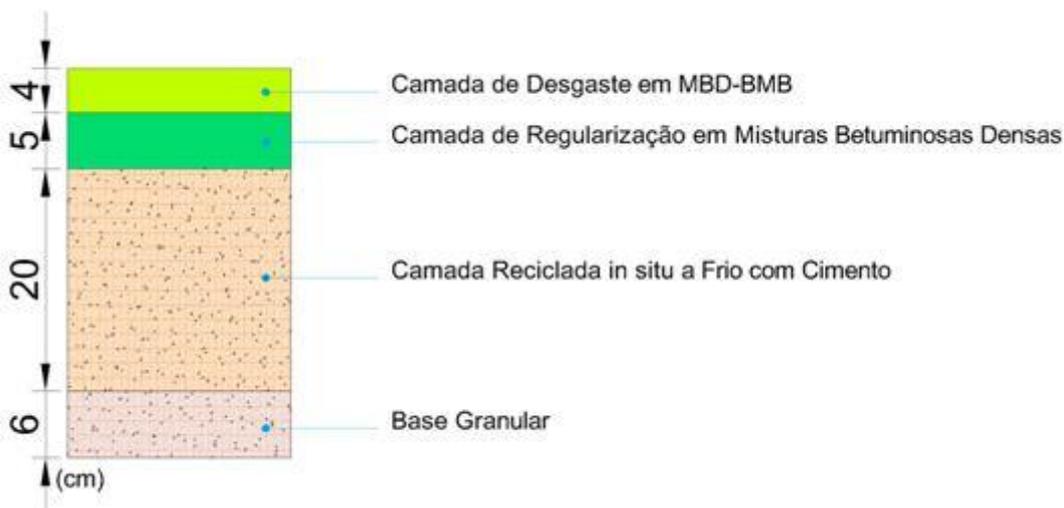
Estrutura do pavimento depois da execução dos trabalhos de reabilitação
